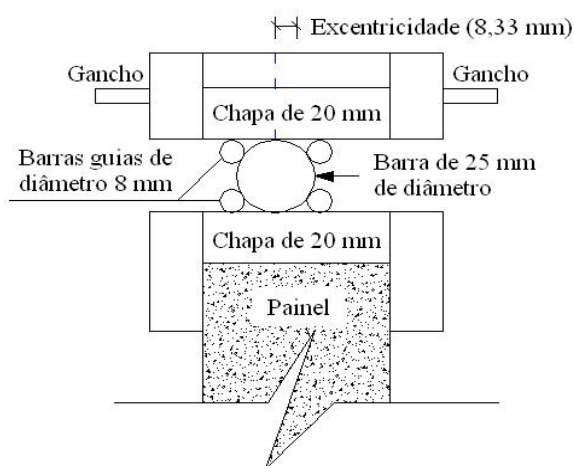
Dispositivo de apoio para o topo dos painéis
